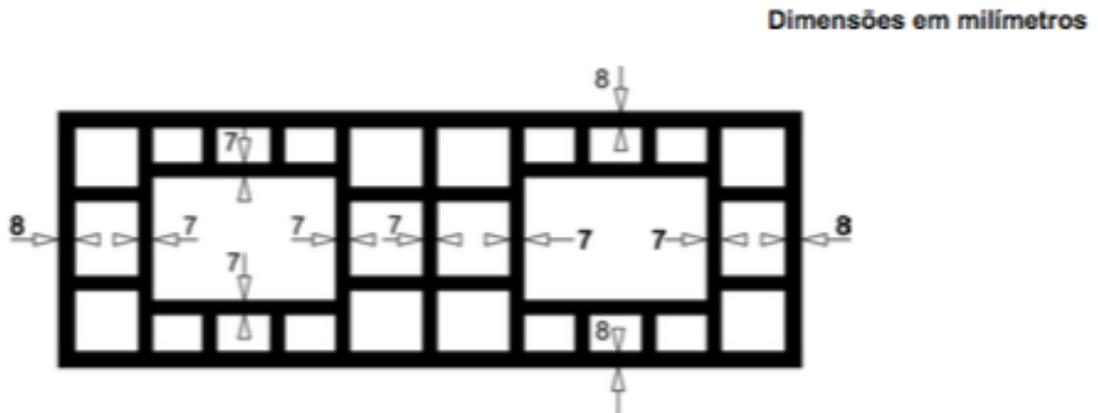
Bloco cerâmico estrutural com paredes vazadas
